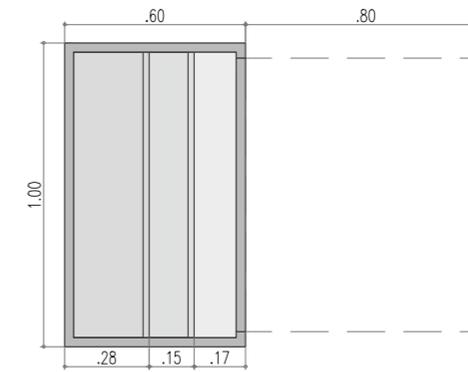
Planta puesto de venta estacionario tipo 1. Esc 1:25
